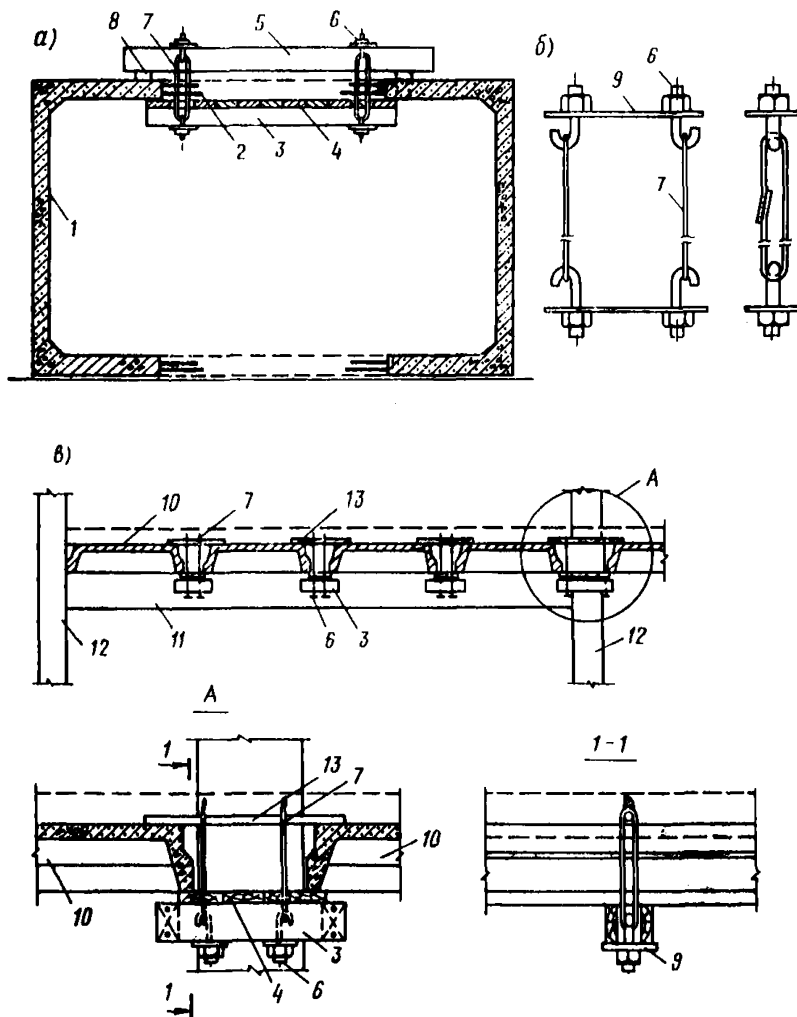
Опалубка сборно-моноконтинентного тоннеля, перекрытия и балки
